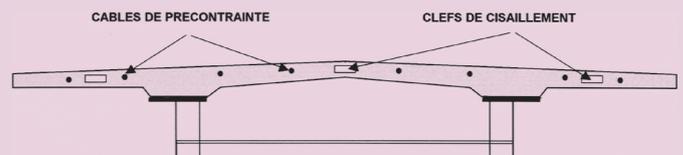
Dalle en voussoirs préfabriqués conjugués collés
